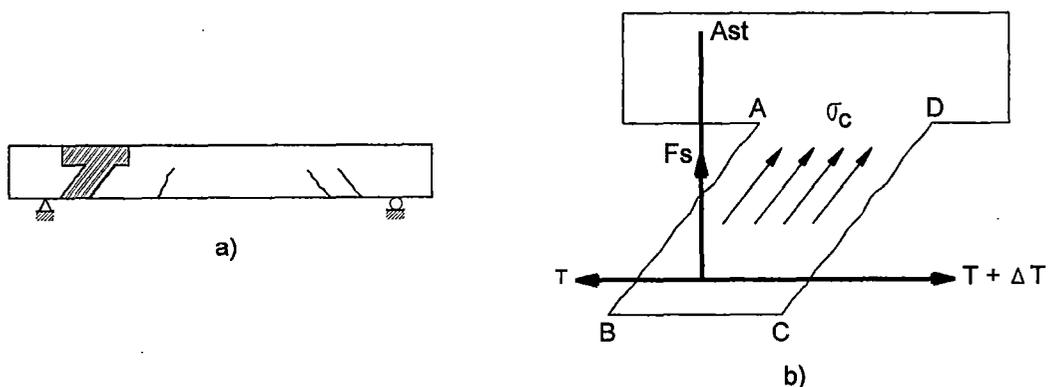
Esquema de resistencia al corte en una viga de concreto armado
